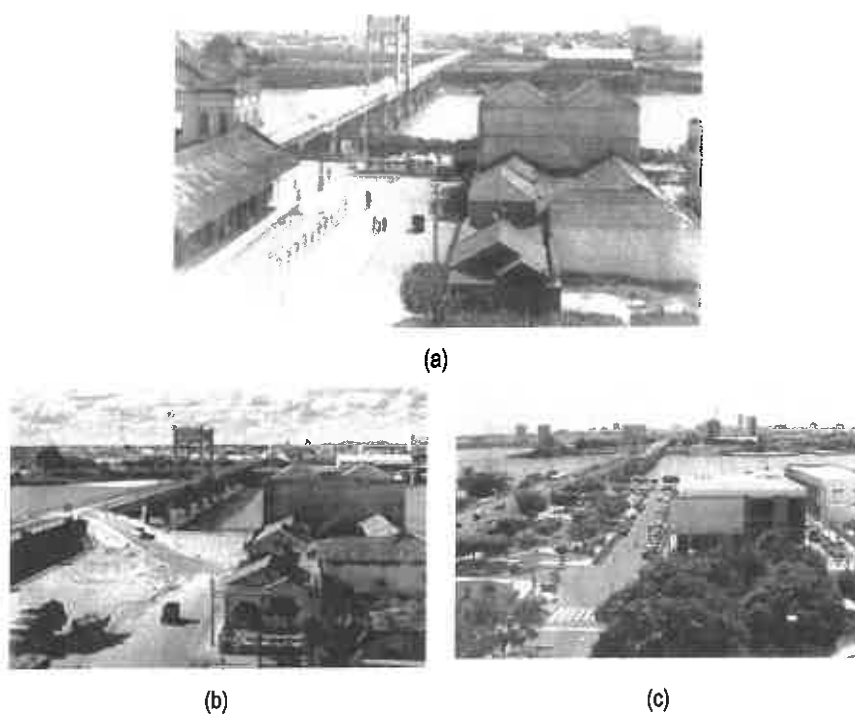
A Ponte Presidente Dutra: (a) Em construção, antes da demolição da Estação da Léste Brasileiro, em 1958; (b) Recém-construída, em 1960; (c) Durante obras de duplicação, em 2008.
